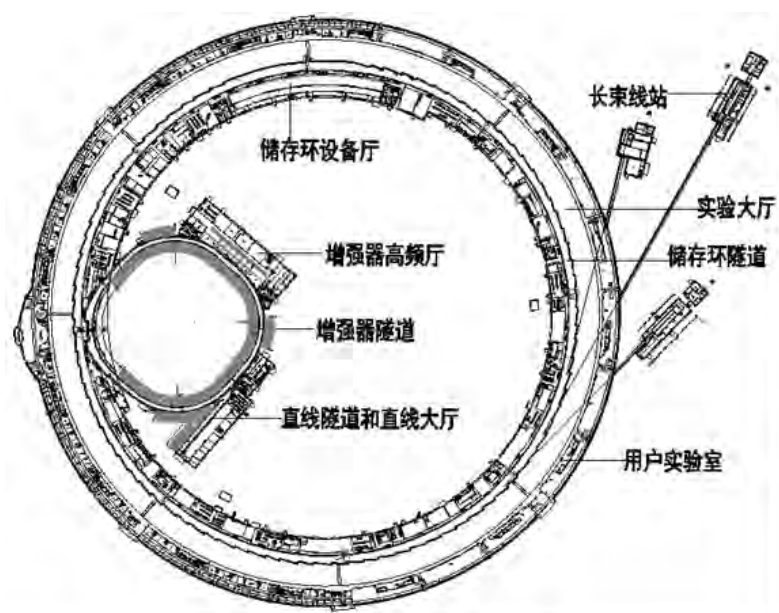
主体环形同步辐射实验建筑平面布置示意图
